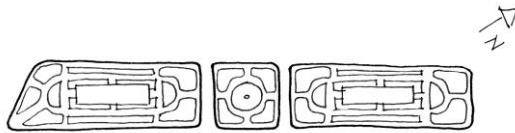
Trazado de los canteros de la Plaza de Casa Forte.
